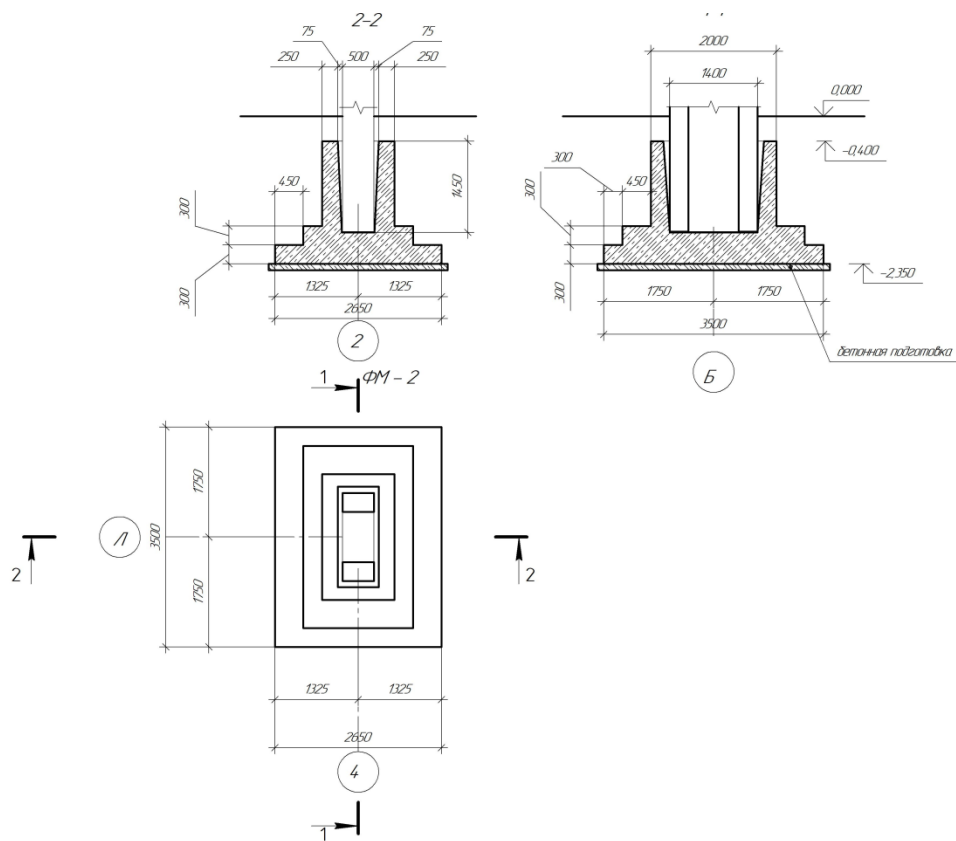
Фундамент среднего ряда ФМ – 2
